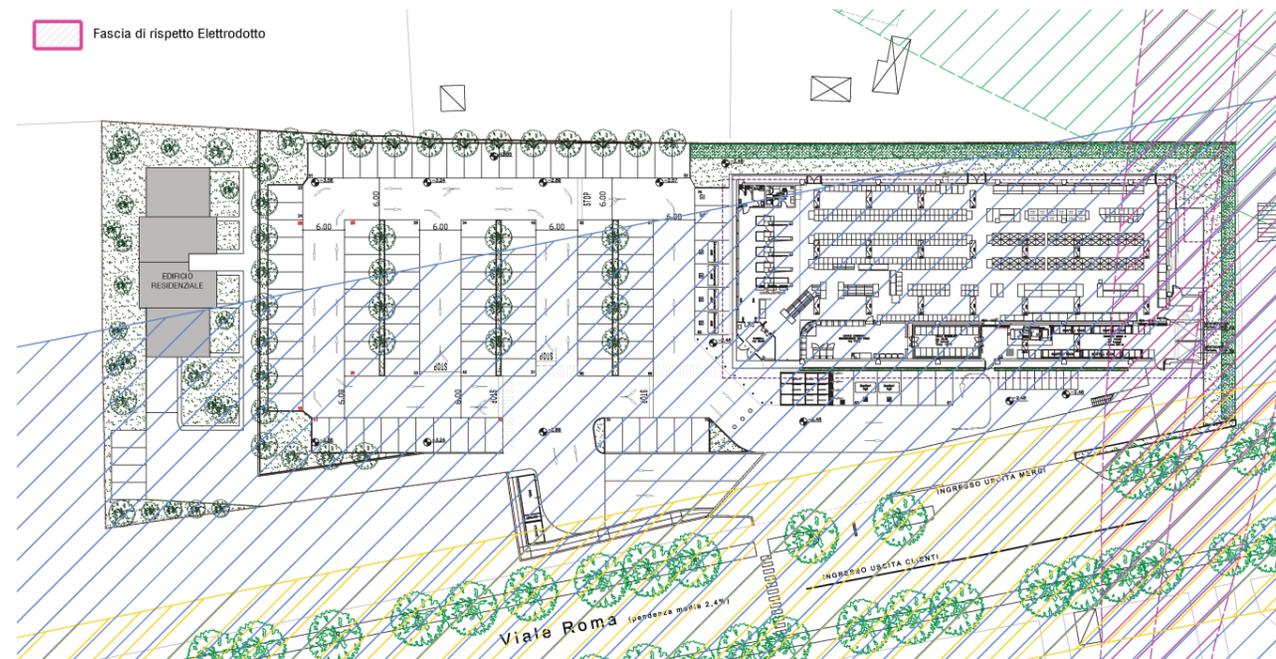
Planimetria Piano Terra con individuazione della fascia di rispetto dell'elettrodotto
